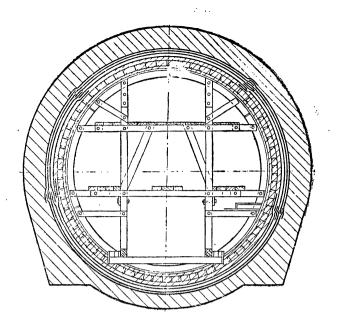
Схема устройства оклеечной гидроизоляции в сводовой части тоннеля
